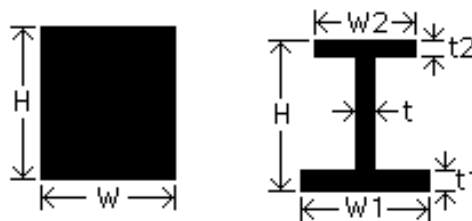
Dimensiones de rigidizador rectangular (izda.). Dimensiones de rigidizador en I (dcha).
